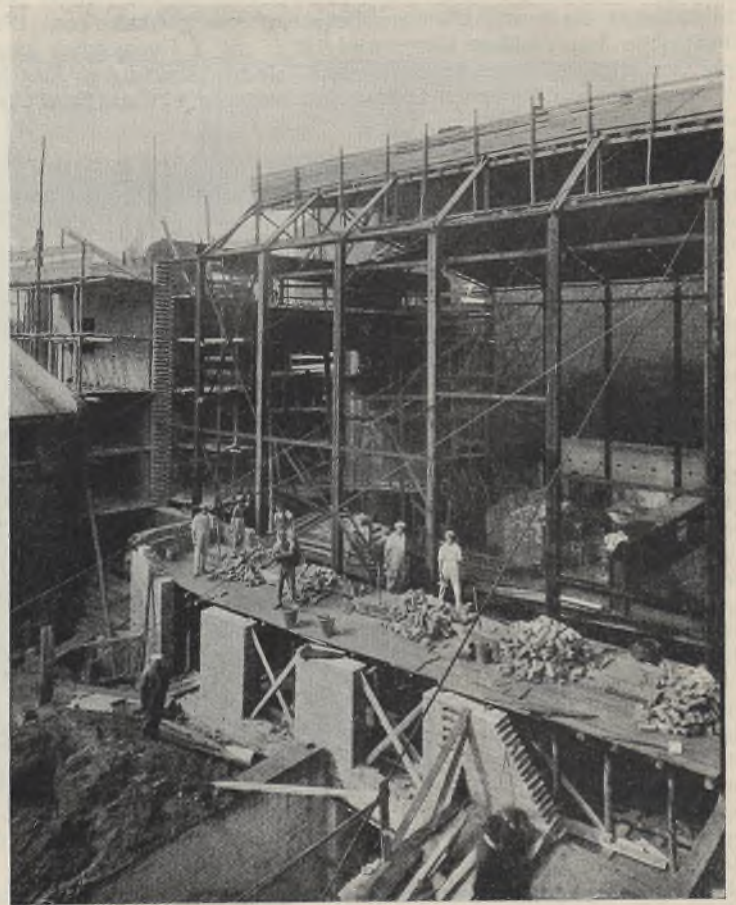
Dachbinder über dem Kino-Zuschauerraum. Das Bühnenhaus links ist z. T. hochgemauert, z. T. eingeschalt.
